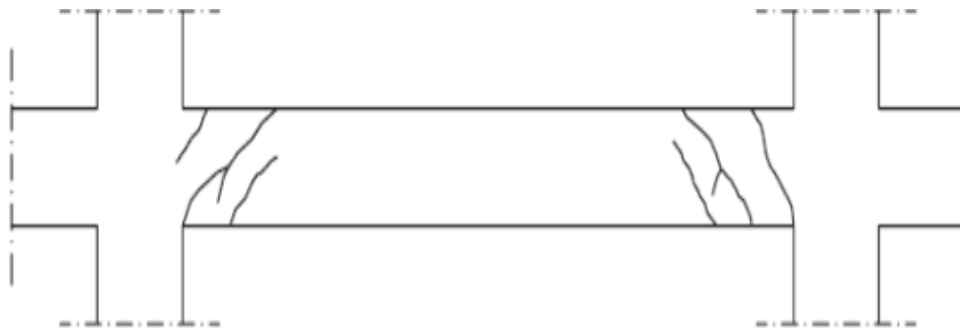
Rupture par cisaillement dans les poutres [41].
